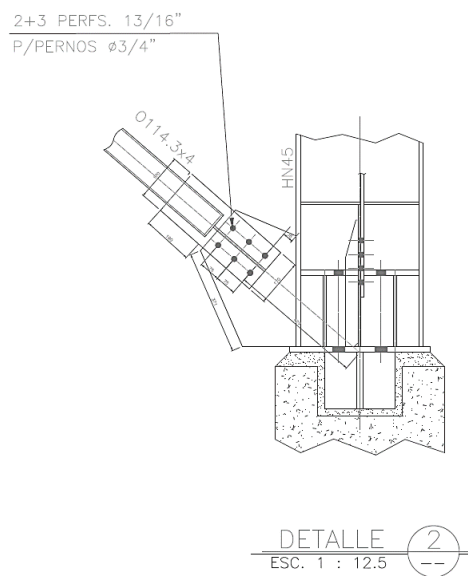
Detalle conexión placa base perfil O114.3X4.
